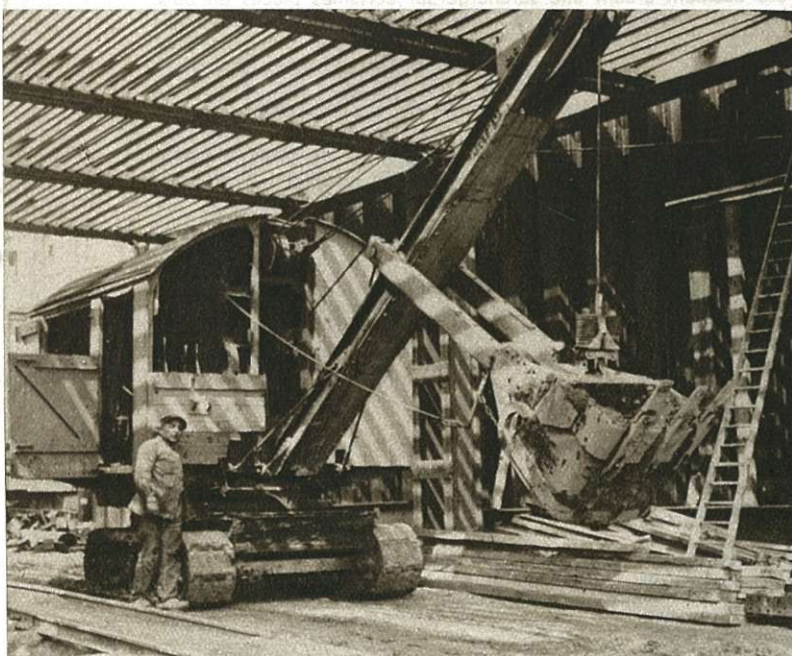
Pelle mécanique travaillant sous le poutrage du plafond du tunnel — 1^{er} tronçon.
